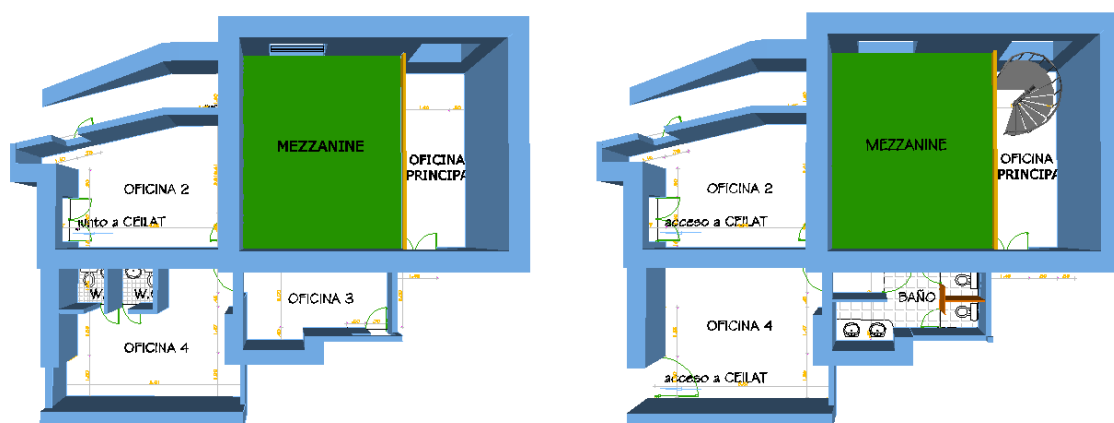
Vistas modelo tridimensional de las instalaciones del CEILAT proyectadas
